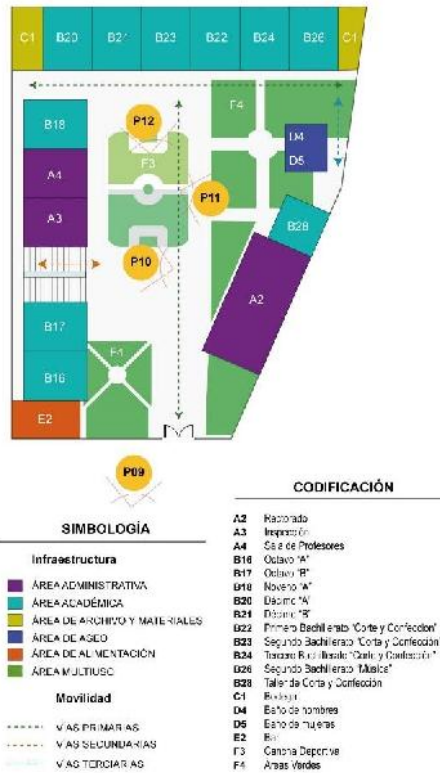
Plano y Puntos de vista - Bloque 3 – Planta Baja
